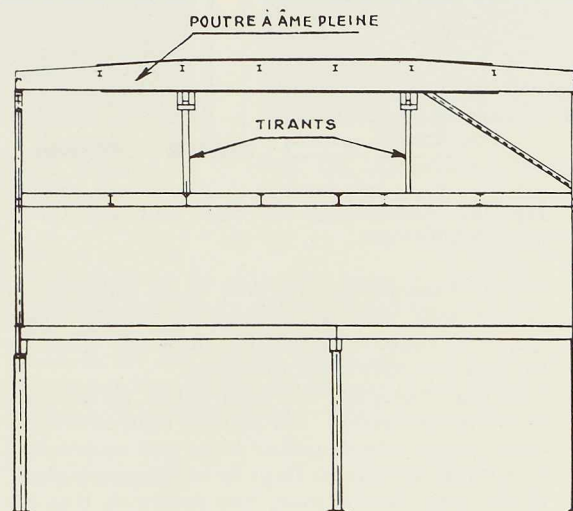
Coupe BB montrant les poutres à âme pleine avec tirants portant le second étage.
